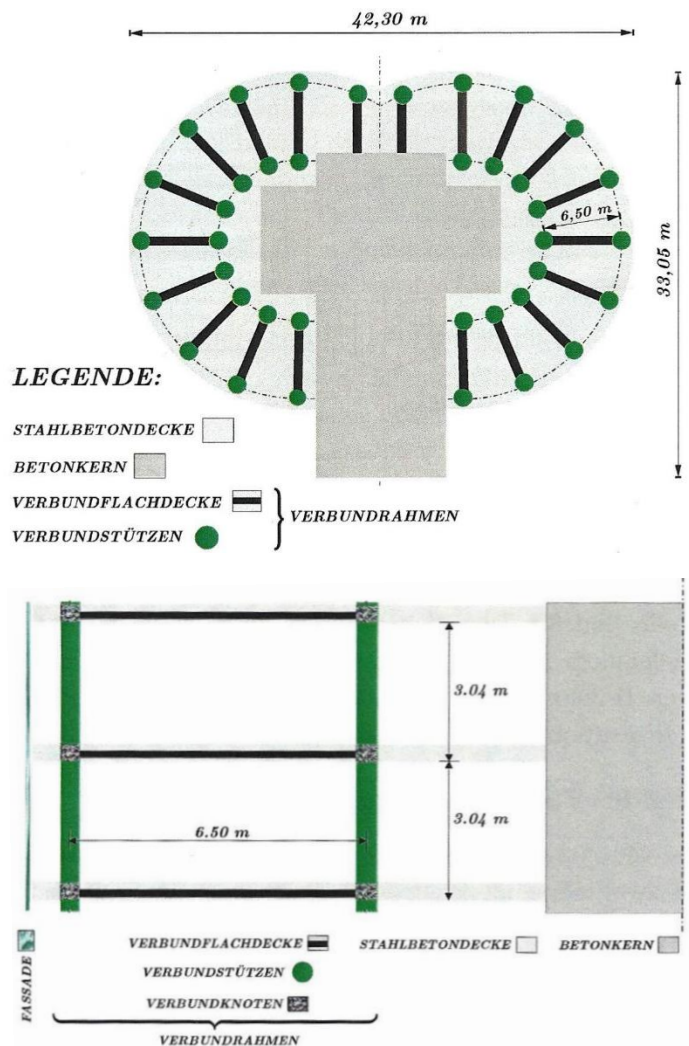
Grundriss und Schnitt der Tragstruktur *Millennium Tower* (Arbeitsbereich f. Stahlbau und Mischbautechnologie, 2015)
